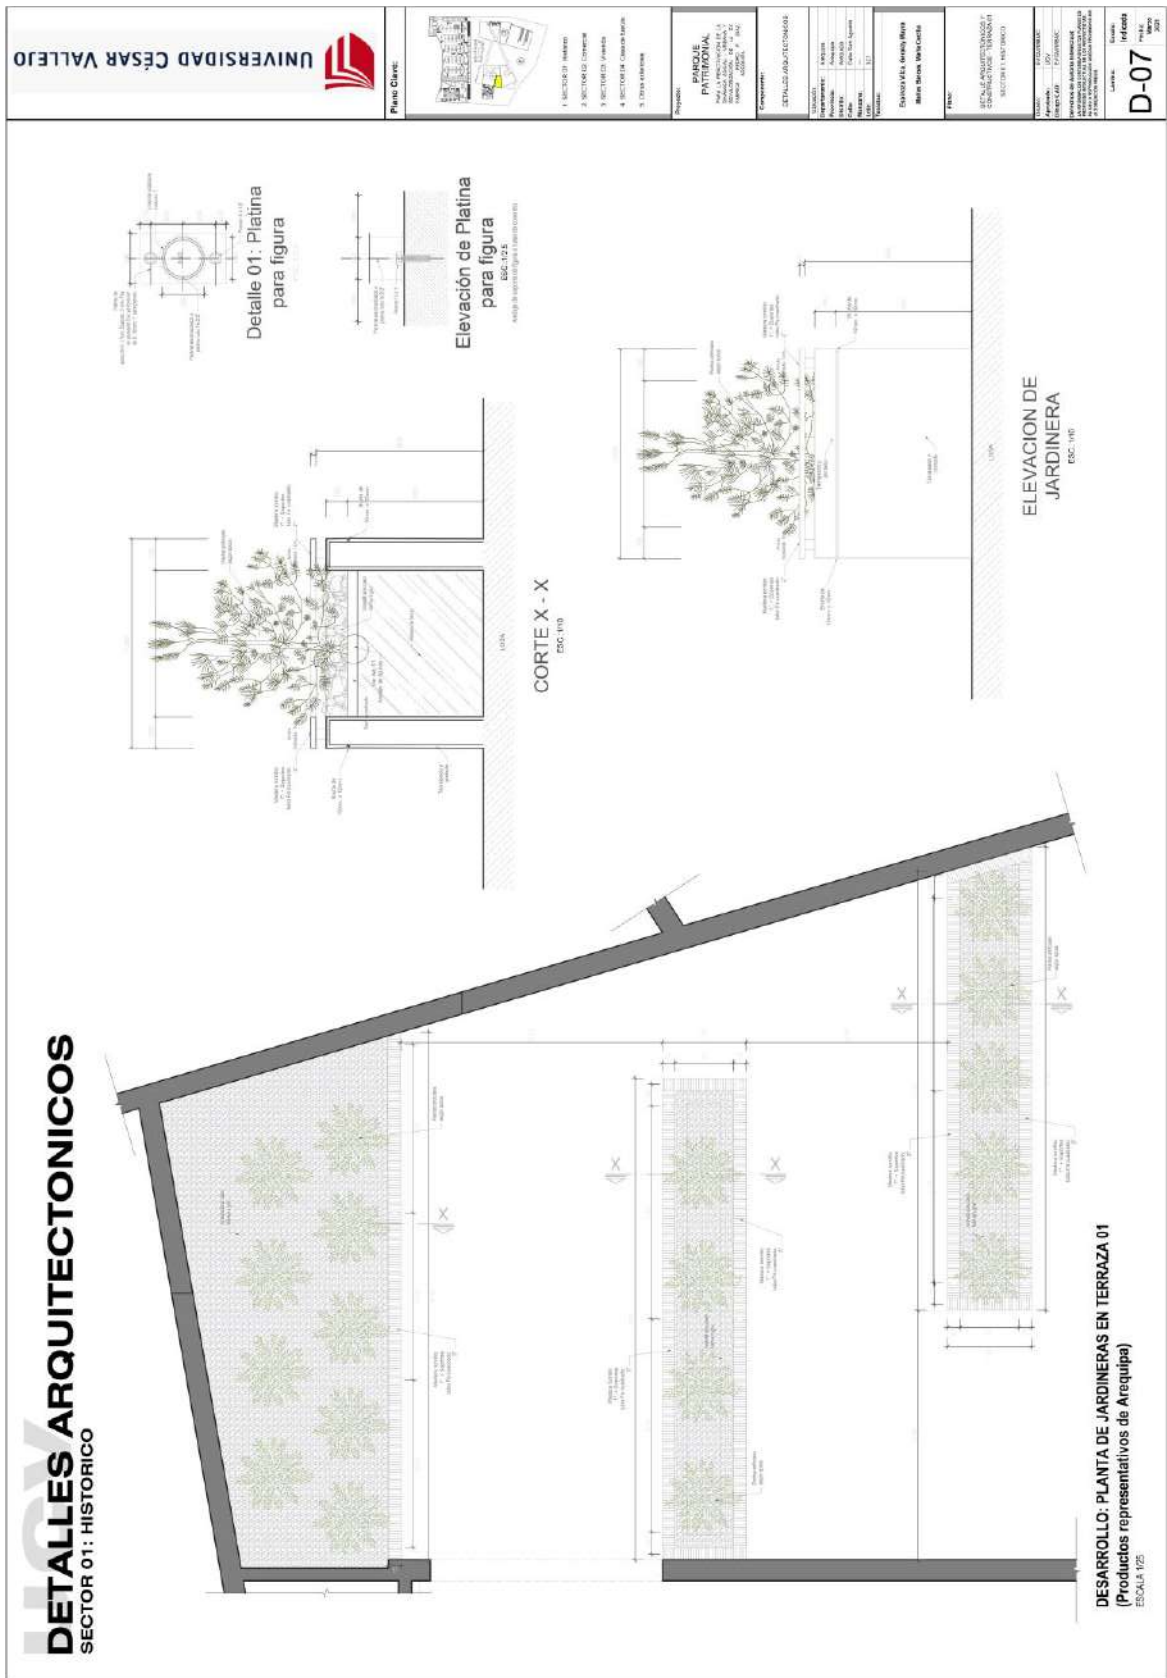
Detalles arquitectónicos de terraza 01 - Sector 1.
